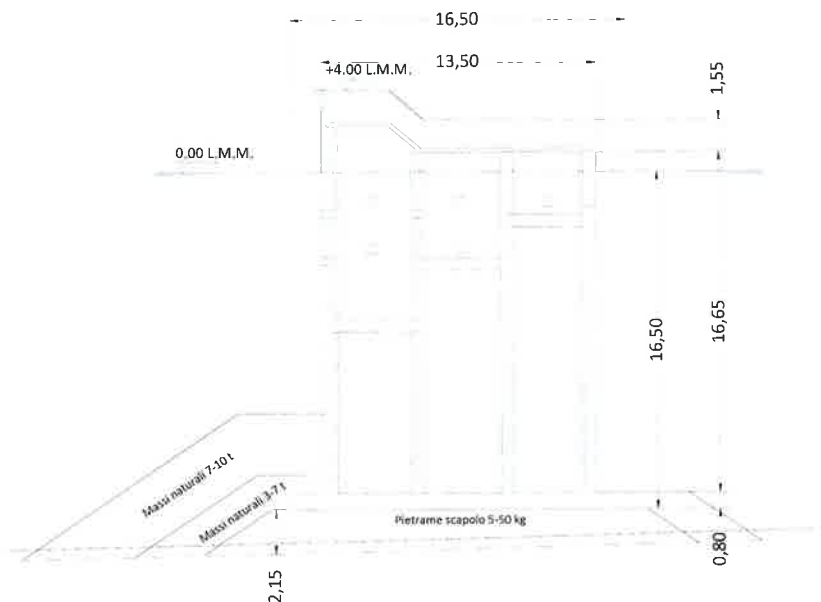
Sezione tipo cassoni della prolungamento dell'antemurale di Ponente
